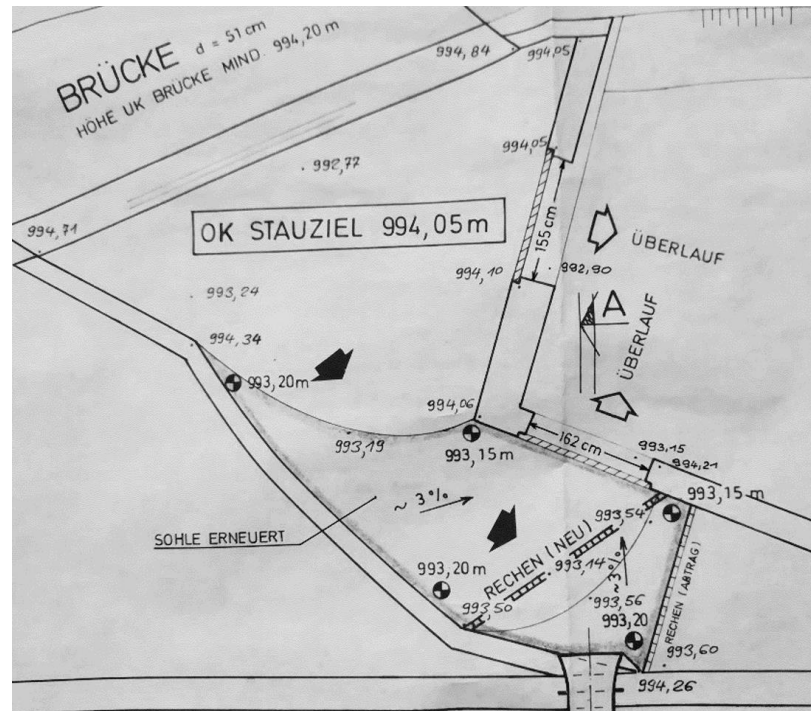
Bestehendes Hubschützenwehr; Auszug aus dem Detaillageplan der Wasserkraftanlage
